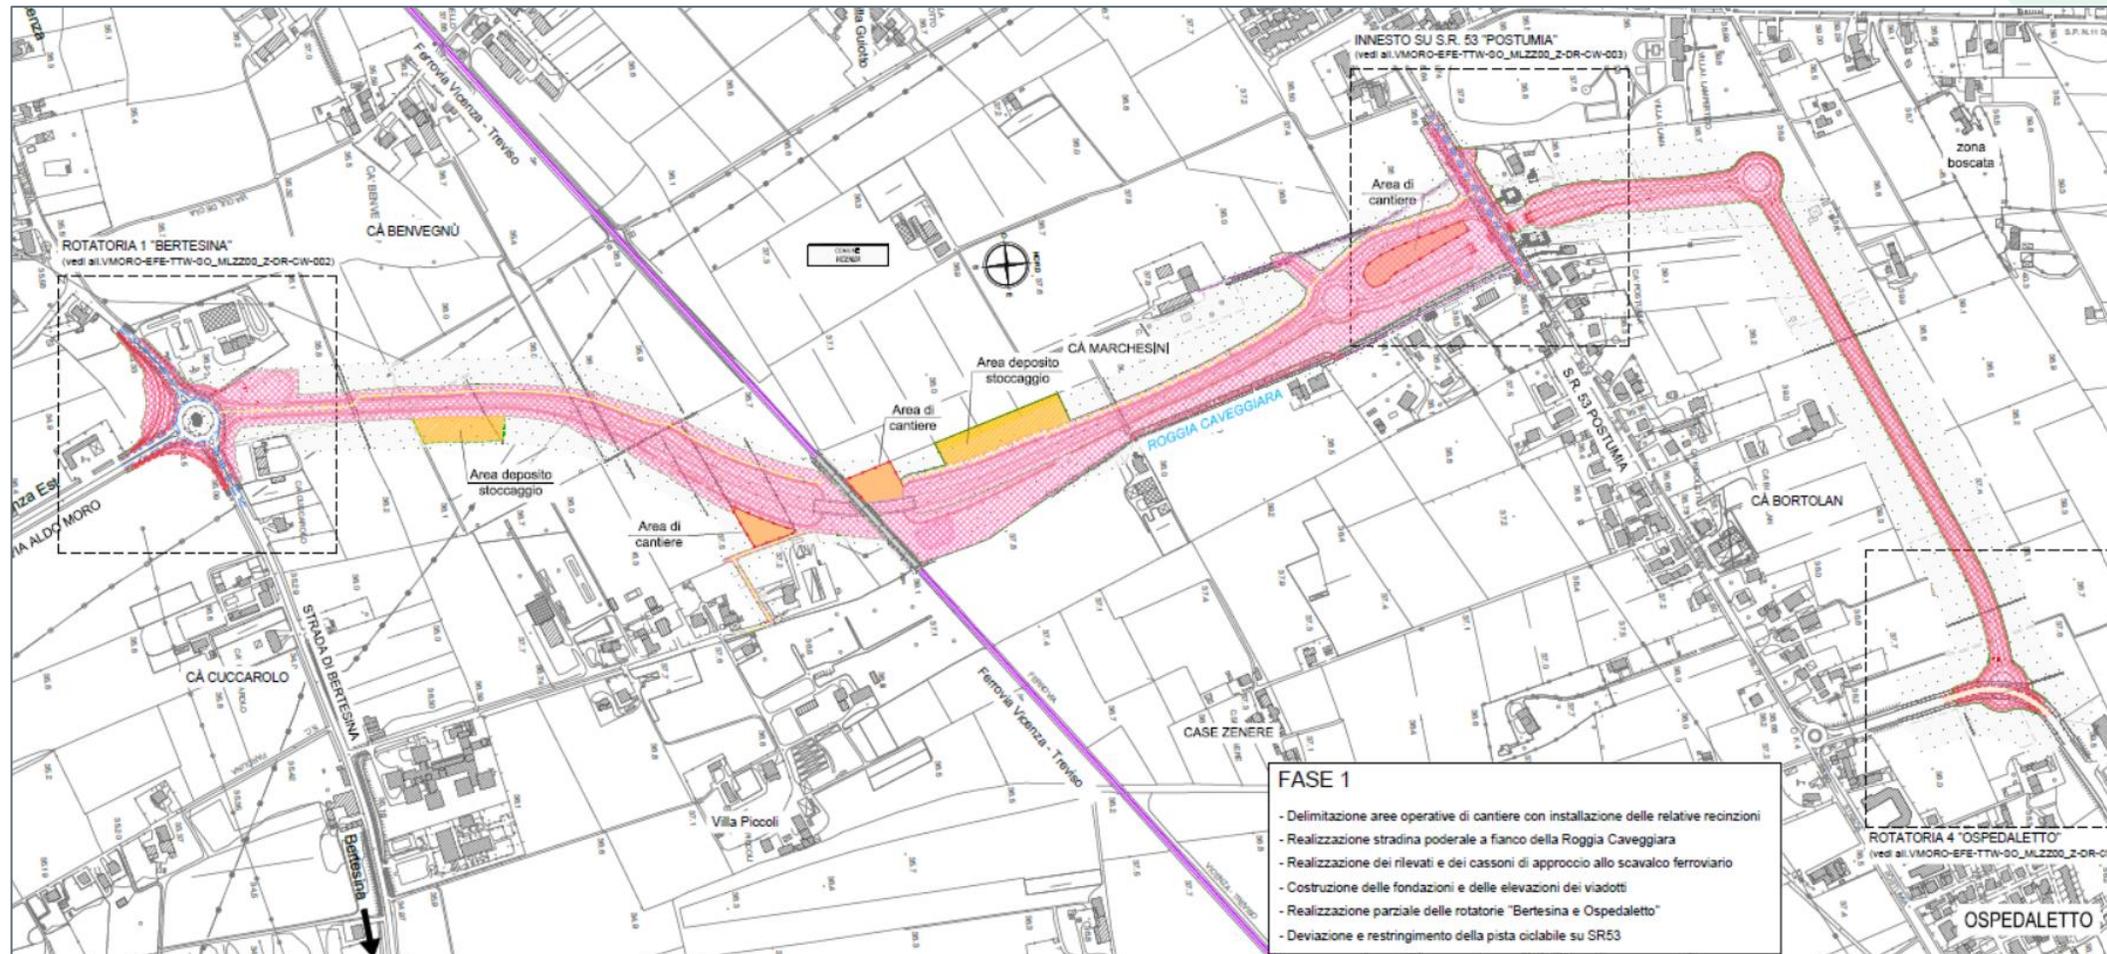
DBM da SoundPLAN®, vista piana con rappresentazione della rete stradale e dell'intervento di progetto.
